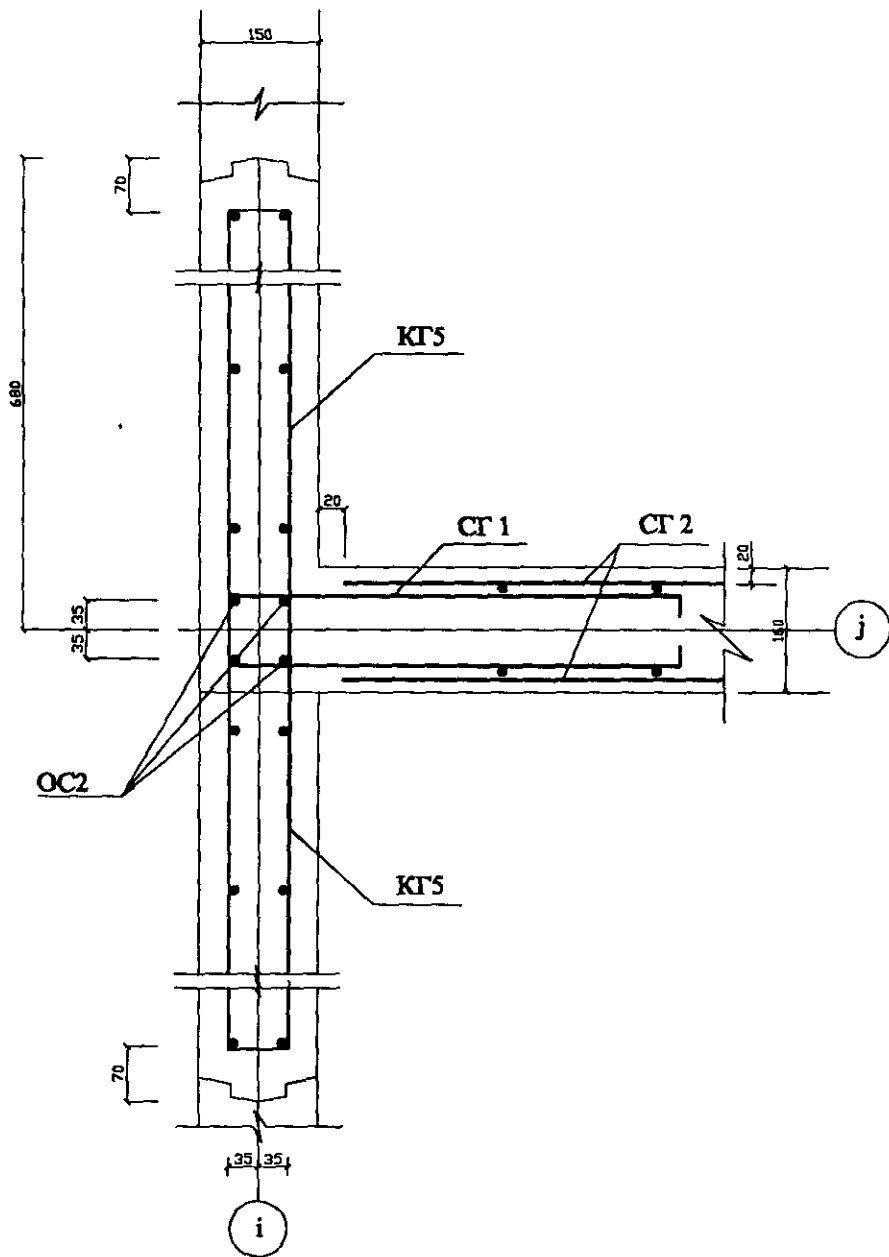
Сопряжение продольных и поперечных железобетонных монолитных стен
